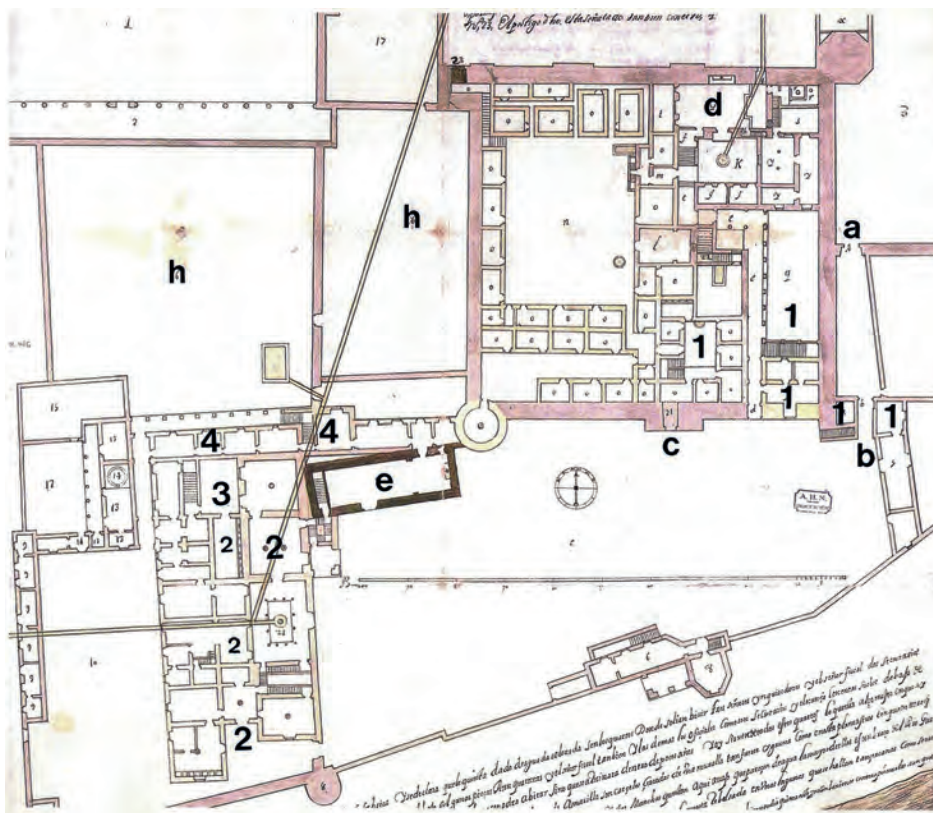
Plano del Alcázar de Córdoba (1662). Archivo Histórico Nacional. Propuesta de distribución: a) primera puerta; b) segunda puerta; c) puerta principal; d) sala real; e) iglesia de «santo Estación»; h) huerta; 1) aposentamiento del rey; 2) aposentamiento de la reina (muy deteriorado en 1662); 3) cuarto del príncipe, cuartos de infantas y aposentamiento de las damas; 4) aposentos de Gutierre de Cárdenas y de Juan Chacón.
